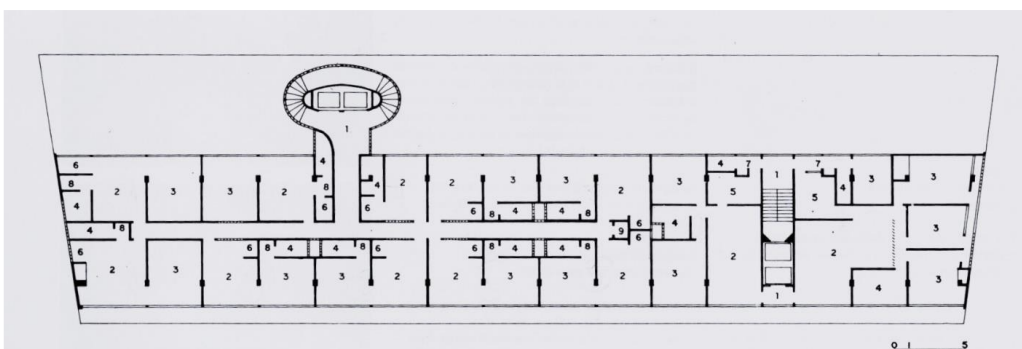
Planta – Edf Pirapama. Fonte: Silva, 1981.
